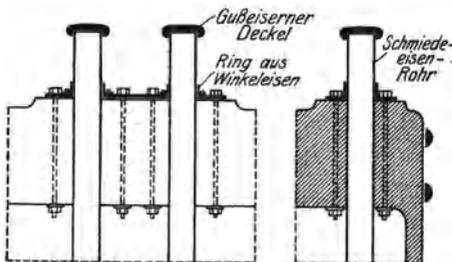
Befestigung eines schmiedeeisernen Pollers.
